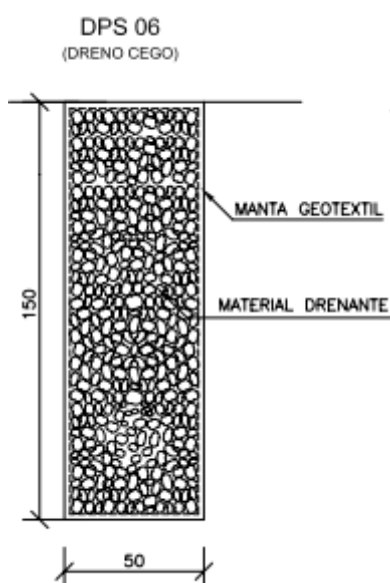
DRENO LONGITUDINAL PROFUNDO. (DPS 06 DRENO CEGO)
